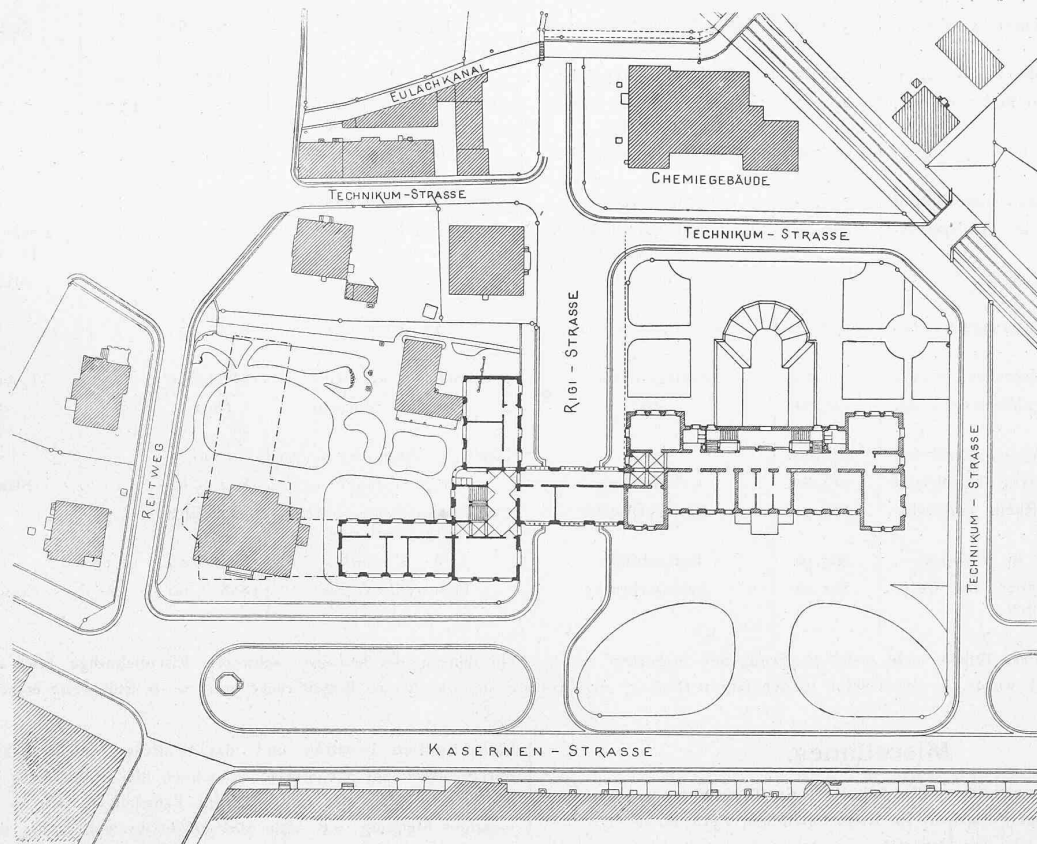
Lageplan und Grundriss vom Obergeschoss. — Masstab 1:1500.
